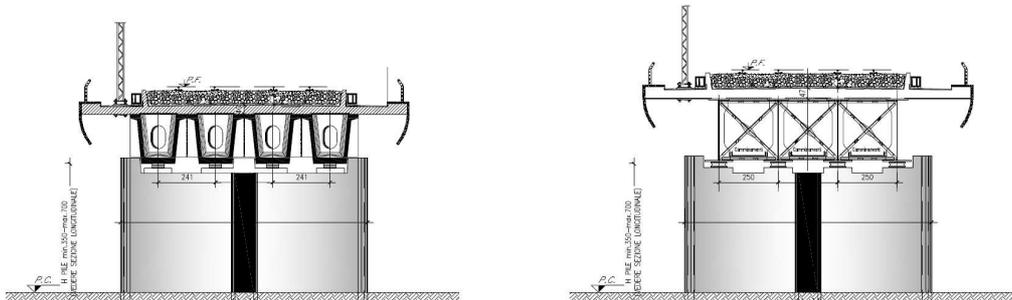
Pila campate 25 - 40 m: viste trasversali
